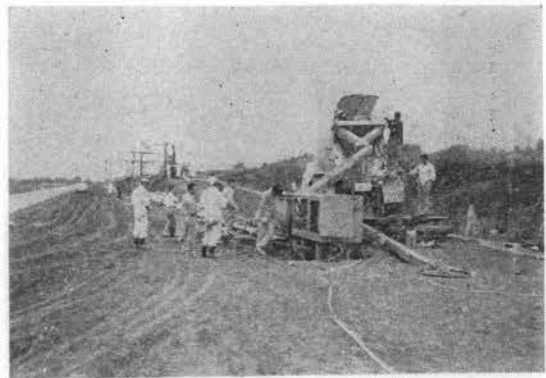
コンクリートポンプの作業テスト (土木用コンクリート)
